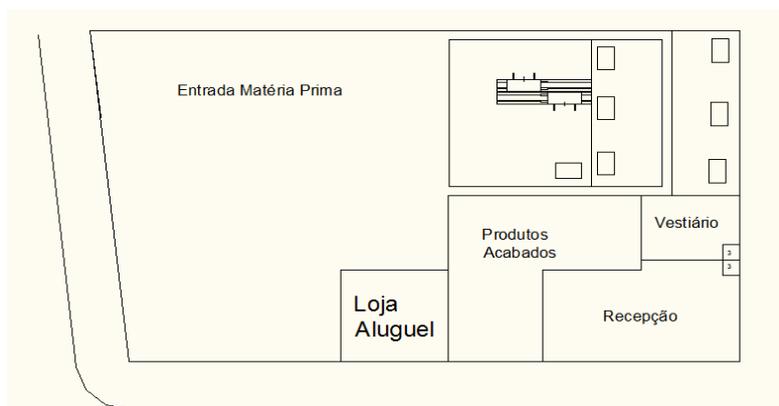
Melhor *layout* projetado. Fonte: Elaboração própria.
